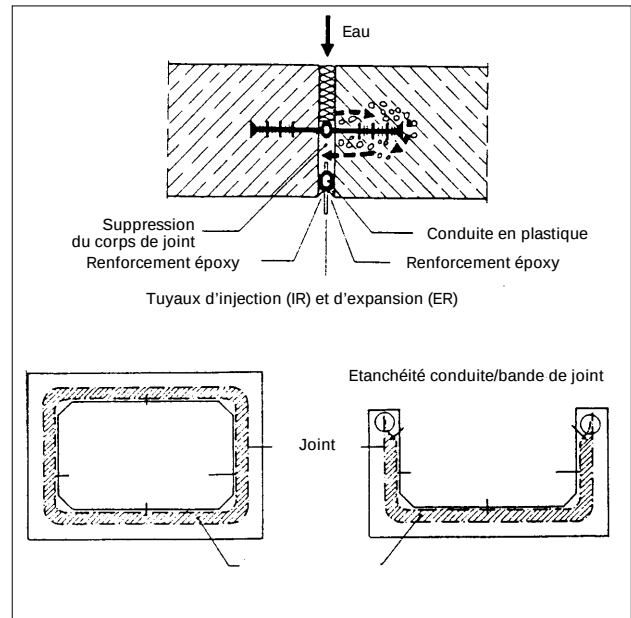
Etanchéité ultérieure, par injection, d'un joint de tassement avec bande de joint intérieure, selon [4.49]
